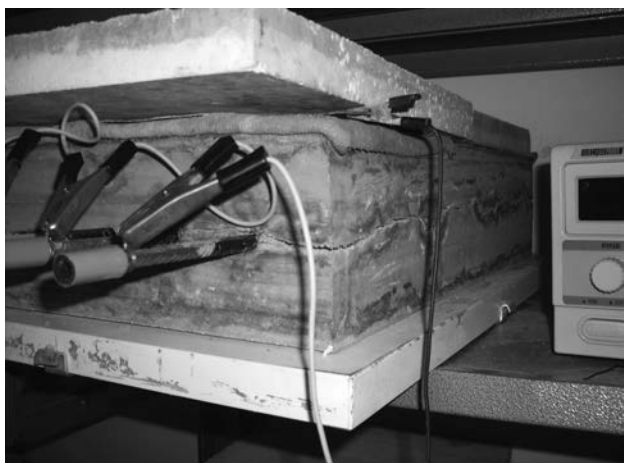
Grieta en la losa durante el ensayo de corrosión acelerada
